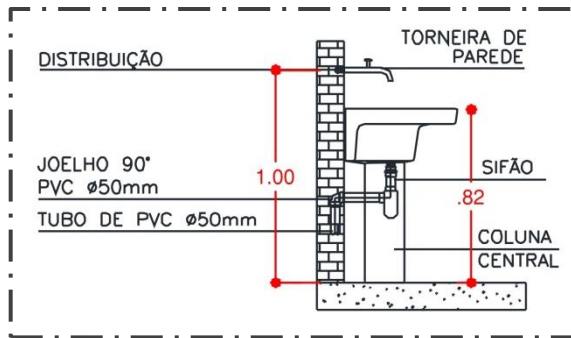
Planta baixa do tanque da área de serviço do apartamento de padrão popular
